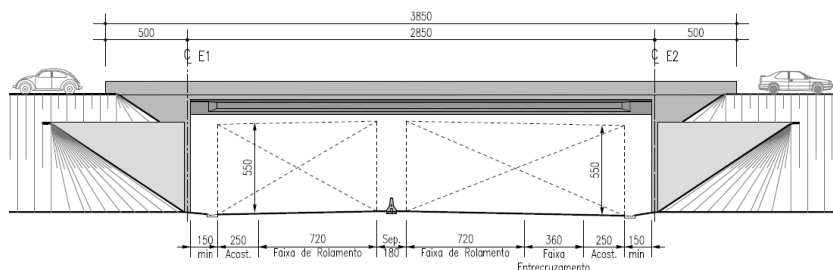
Passagens Inferiores com barreira rígida e faixa de entrecruzamento num sentido. Elevação.
